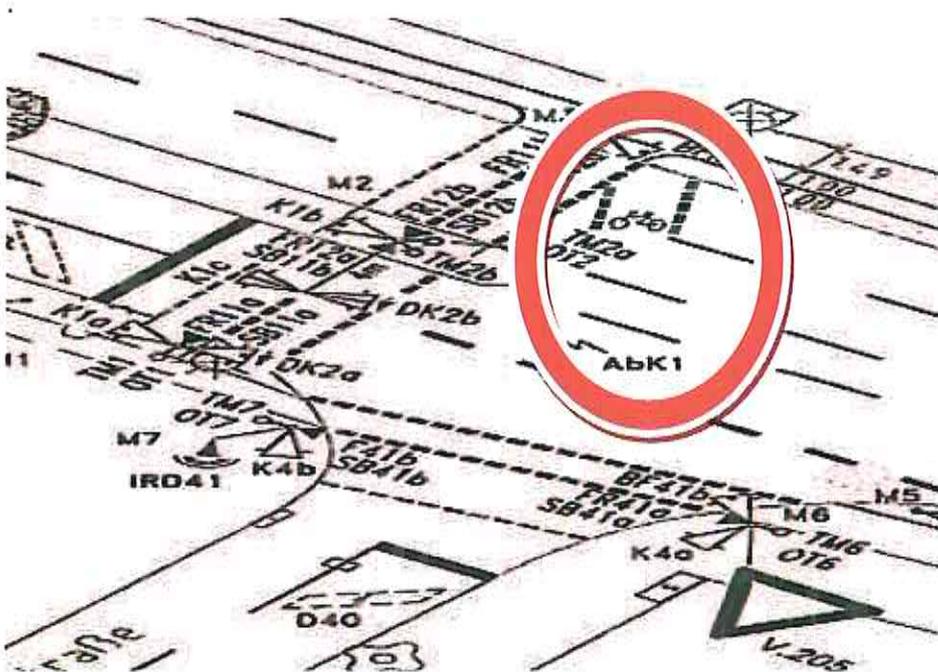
Mögliche Markierung für einen linksabbiegenden Radfahrer (Quelle PVT Planung in Hildesheim)
